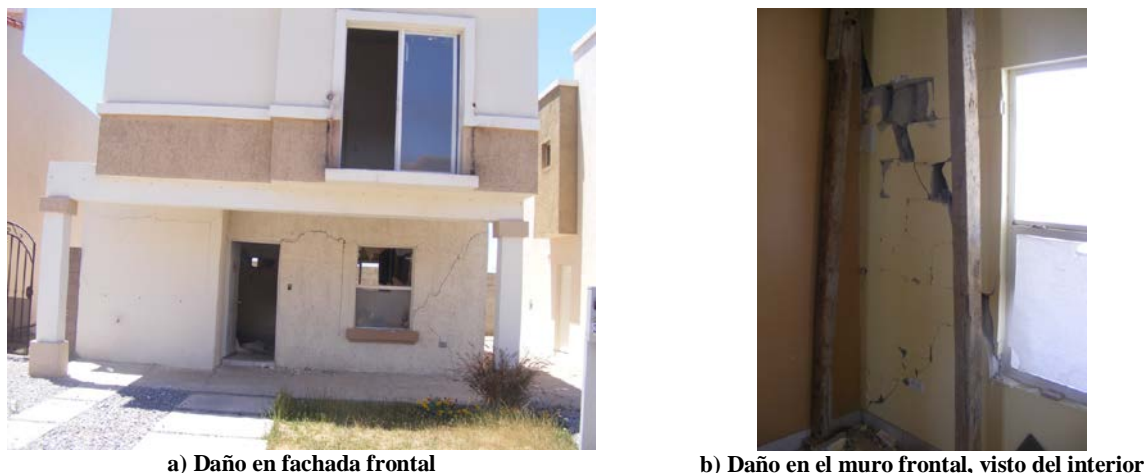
Daño observado en la fachada frontal de la Vivienda B.
